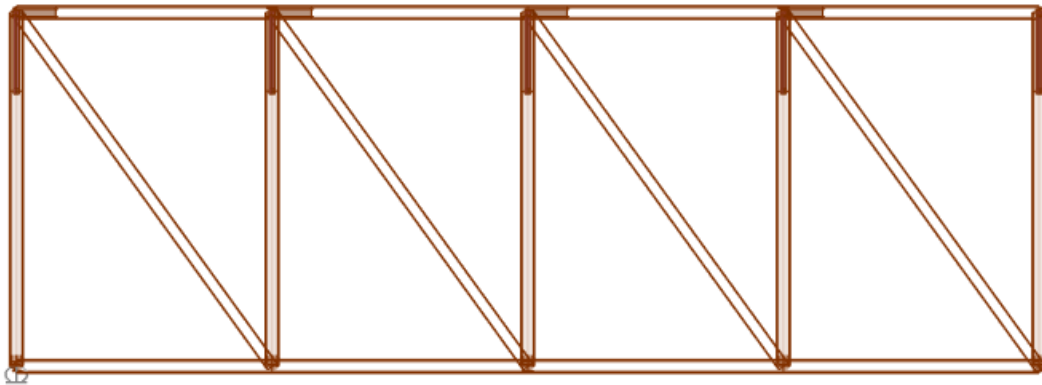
Detalle planta cordón superior (mitad tramo 1).
